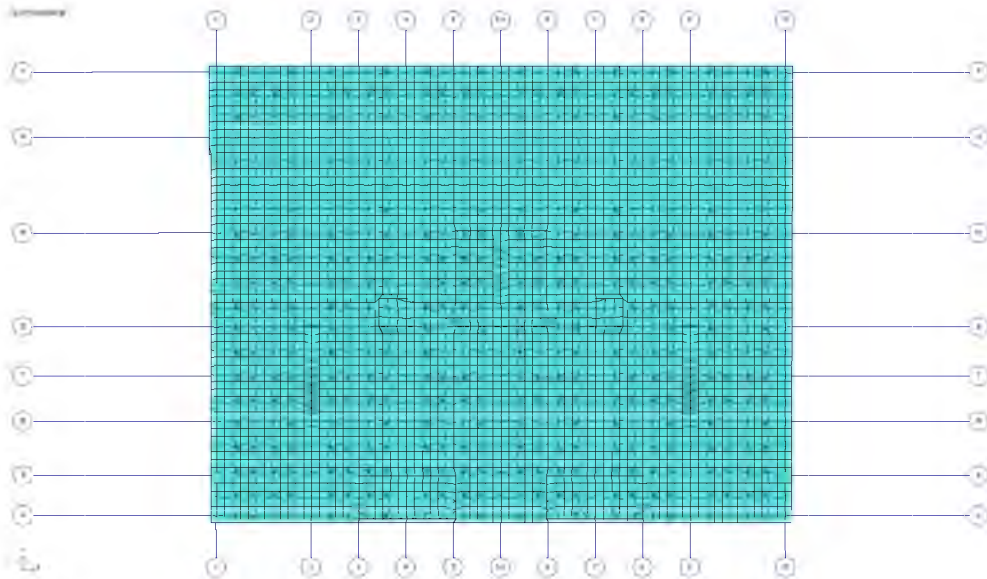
Розрахункова модель фундаментної плити на пальовій основі
